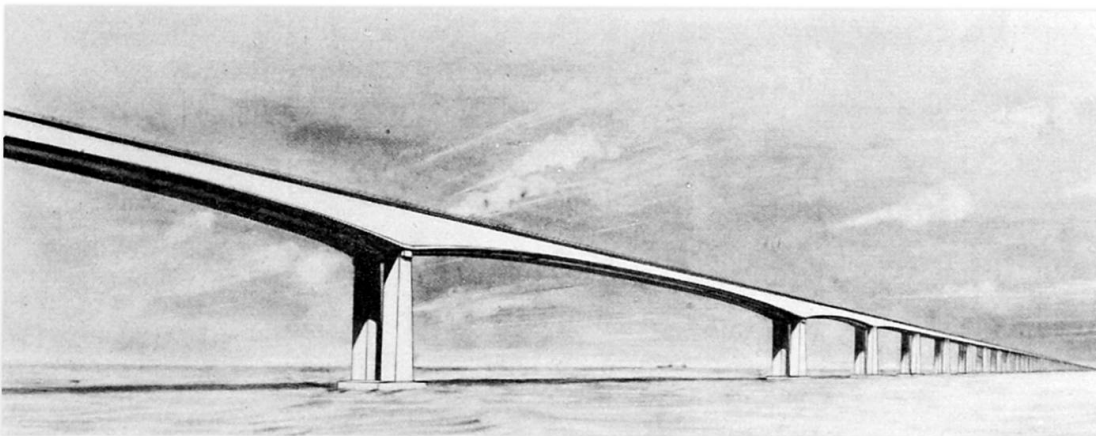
Wettbewerbsentwurf einer Spannbetonbrücke
